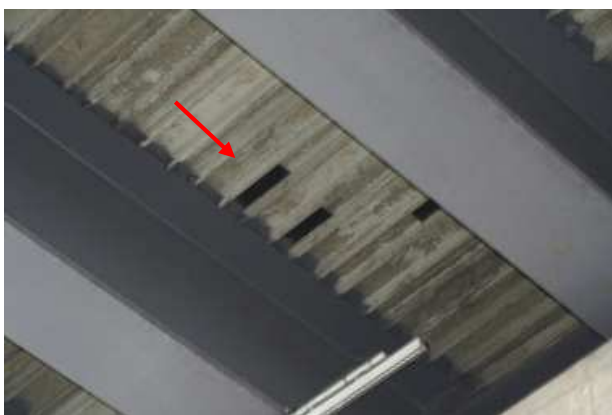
att. Plaisas laiduma konstrukcijas sānu sijās.
